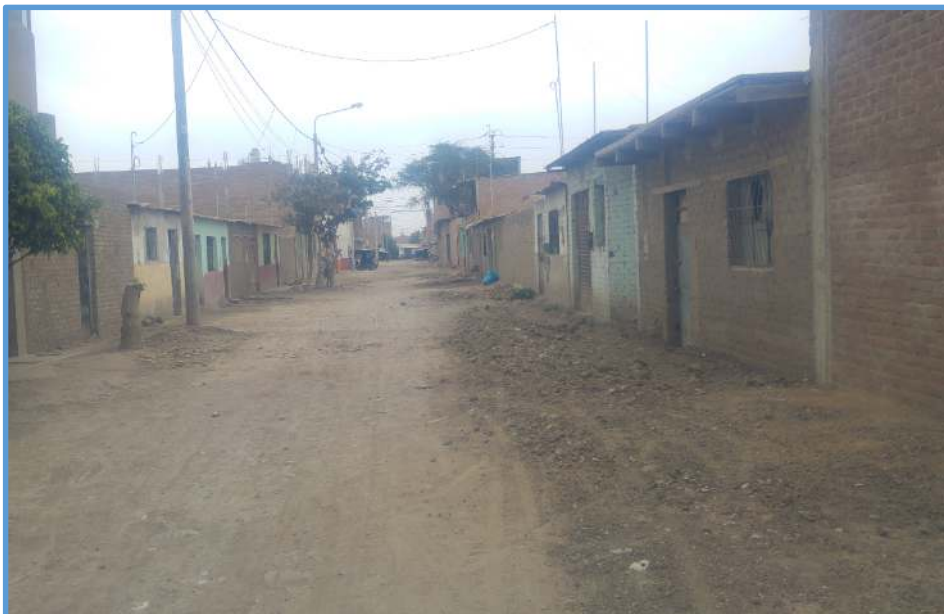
Viviendas del Pueblo Joven Santa Elena sin conexiones a una red de alcantarillado
